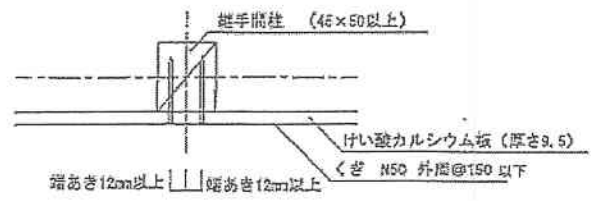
施工図：継手を設ける場合（上部横張り）（寸法単位：mm）
